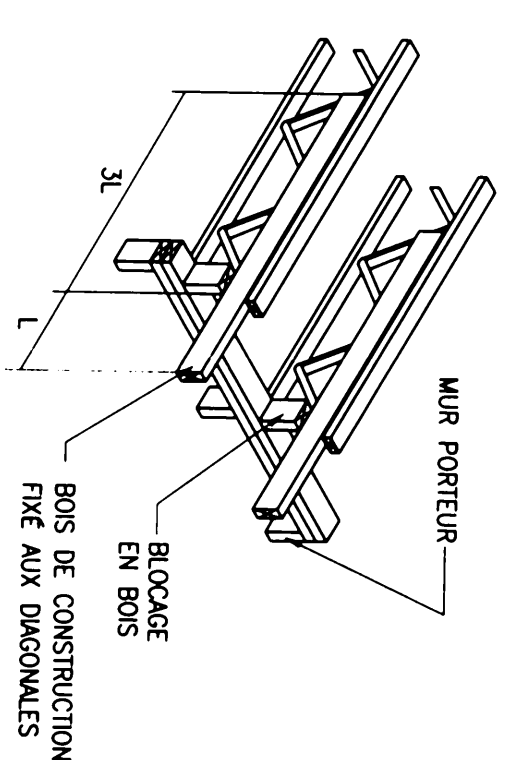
DETAIL TYPIQUE POUTRES DE RIVE PERPENDICULAIRES AUX POUTRELLES
